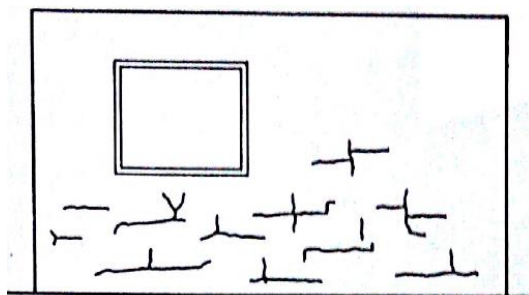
Fissuras em parede externa, promovidas pela retração da laje de cobertura - Fonte: THOMAZ (1989)
